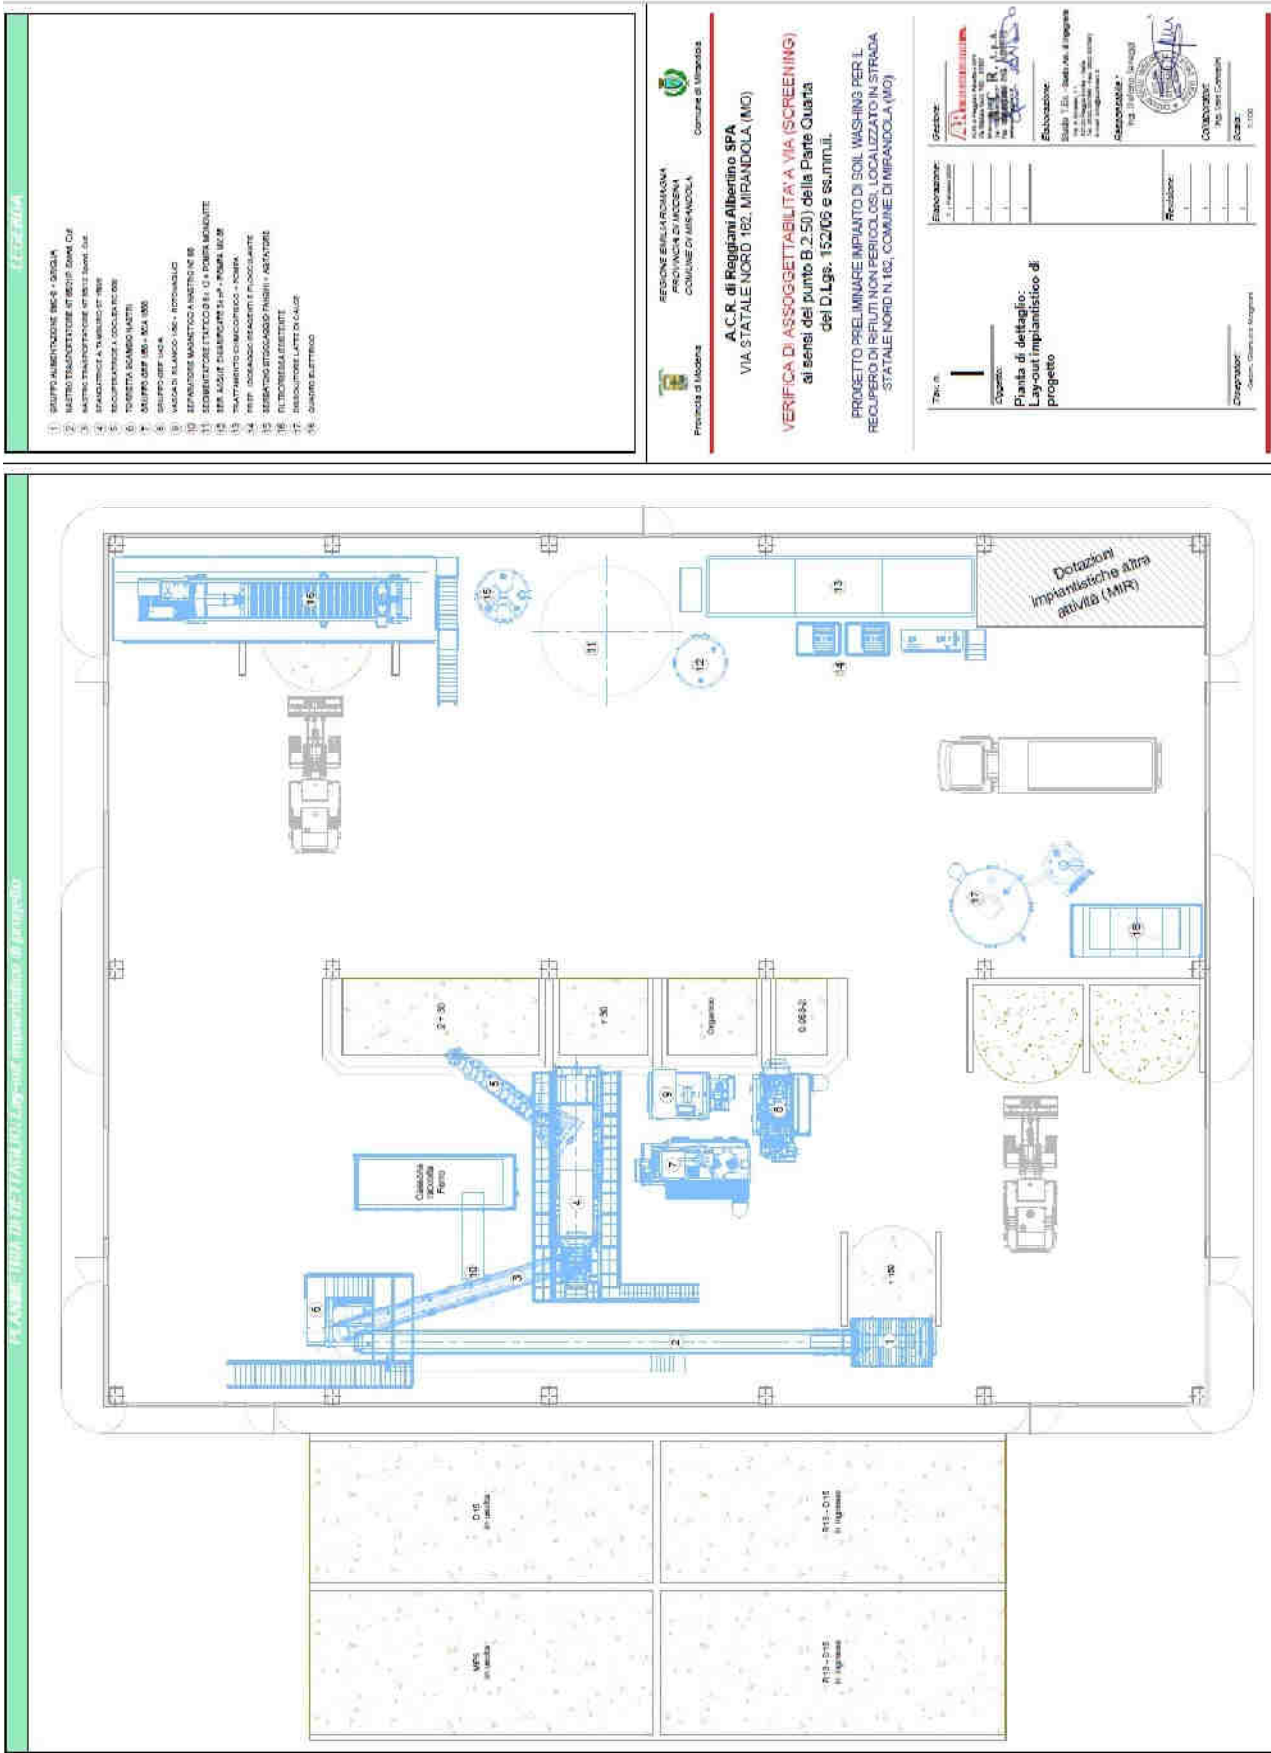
layout macchinari ed impianti, con nuove baie di carico/scarico.
